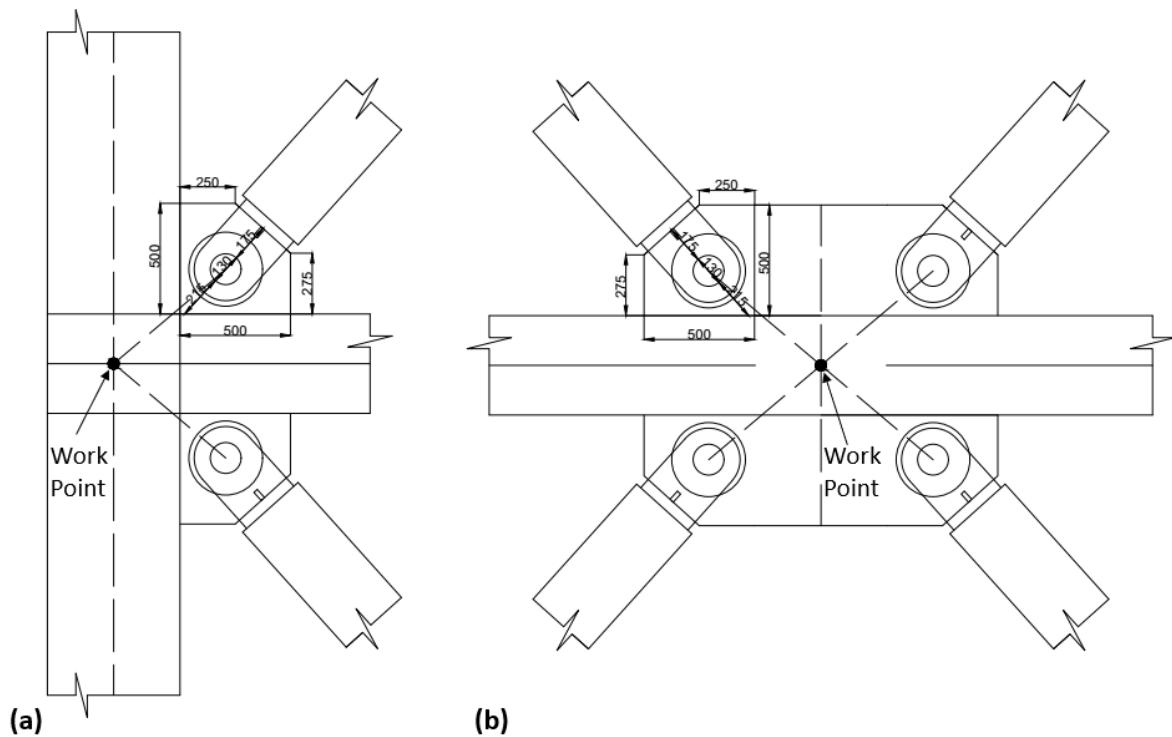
Detalle de Conexión placa Gusset: (a) conexión viga-columna; y (b) conexión viga-viga.
